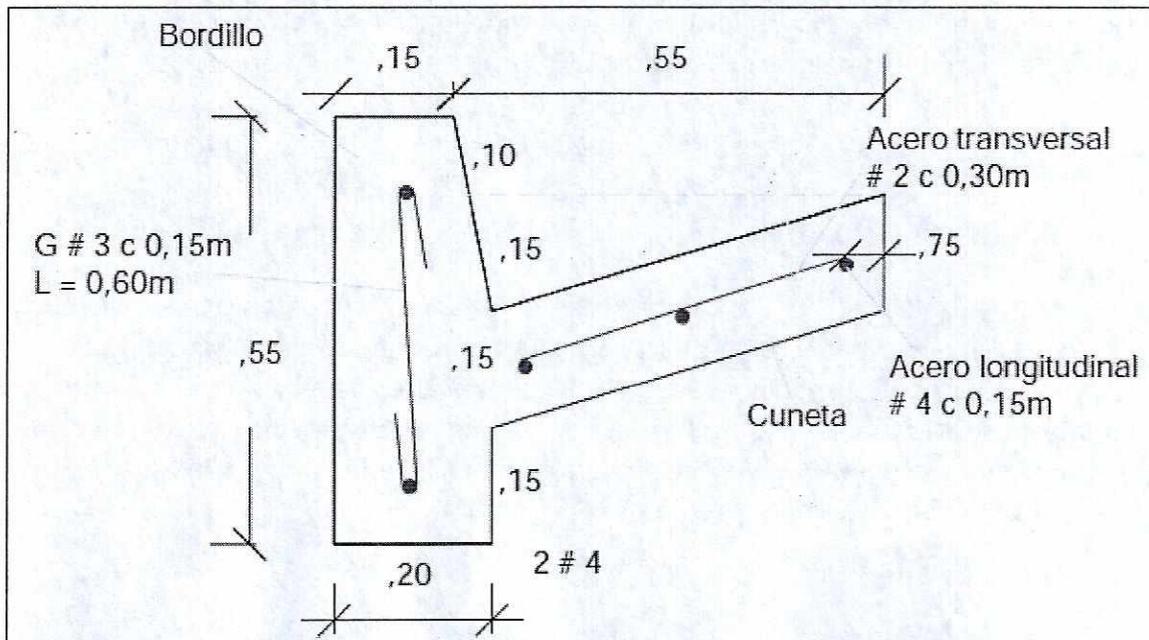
Detalle en corte de la distribución del refuerzo de la berma cuneta y bordillo.
